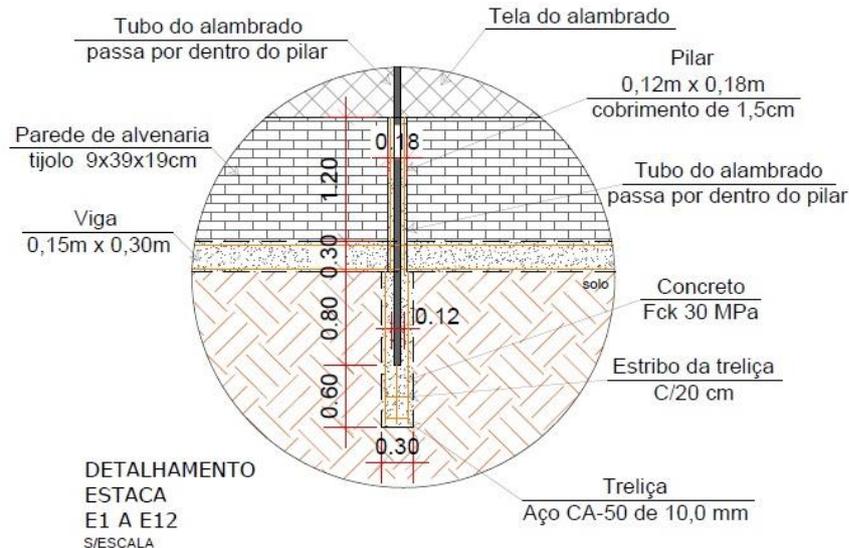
Detalhamento de estaca (Fonte: Autora/2021)
